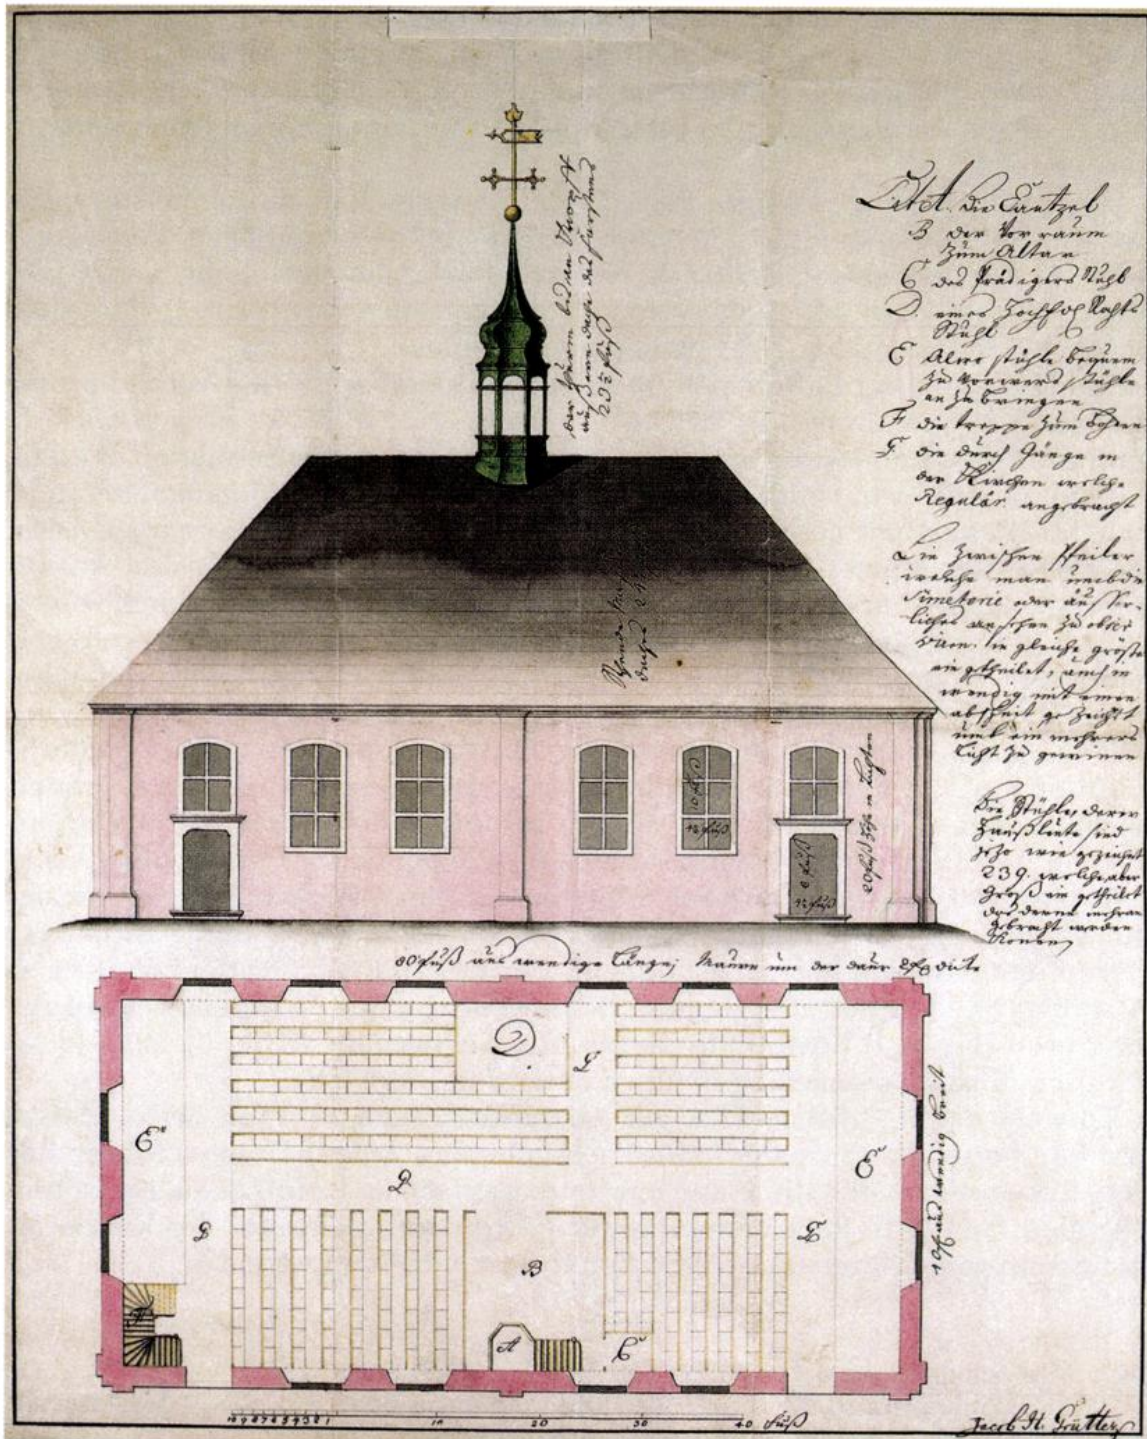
Bauplan von Ratsmaurermeister Grütter für die Rablinghauser Kirche, der zur Bauausführung angenommen wurde (41 x 51 cm). (Foto: StA Bremen)
